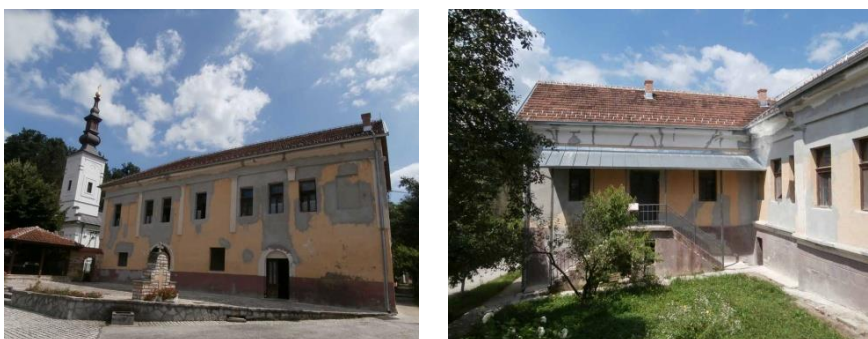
Fotografije sanacija i rekonstrukcija krovne konstrukcije
